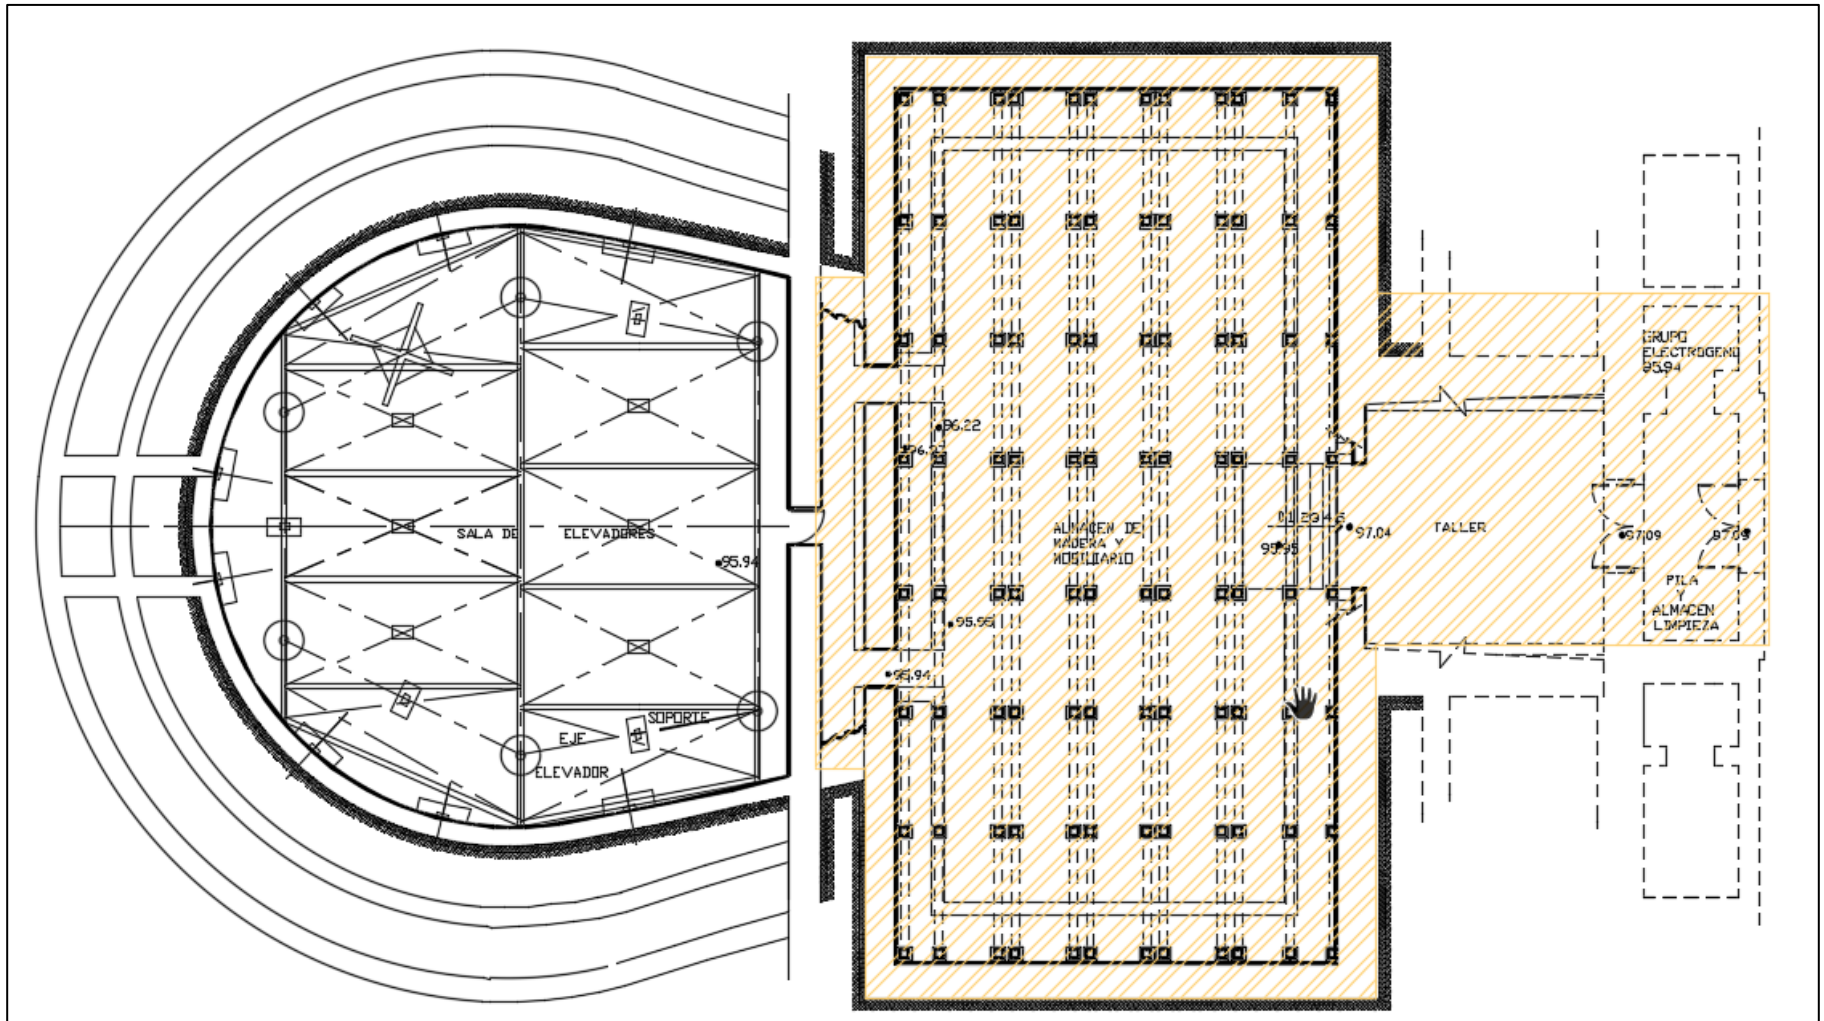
Vista en planta del Nivel 2 de Sótanos
